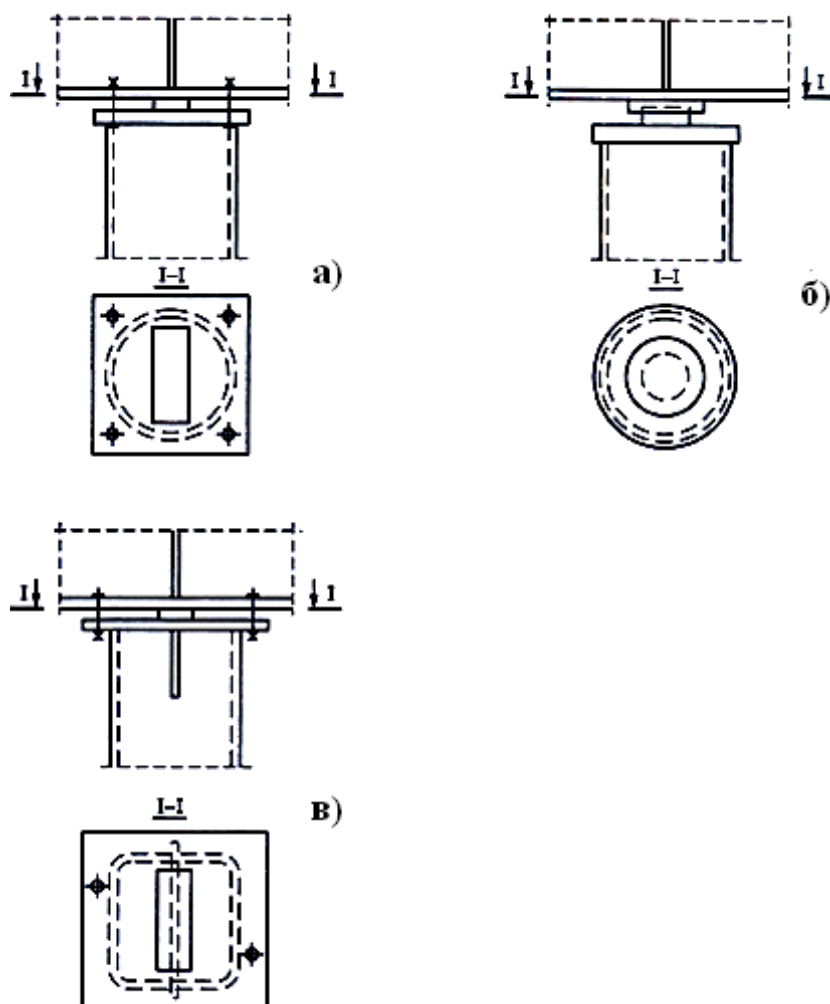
Шарнирное сопряжение двутавровых ригелей с оголовком трубобетонной колонны круглого (а, б) и коробчатого (в) сечений
